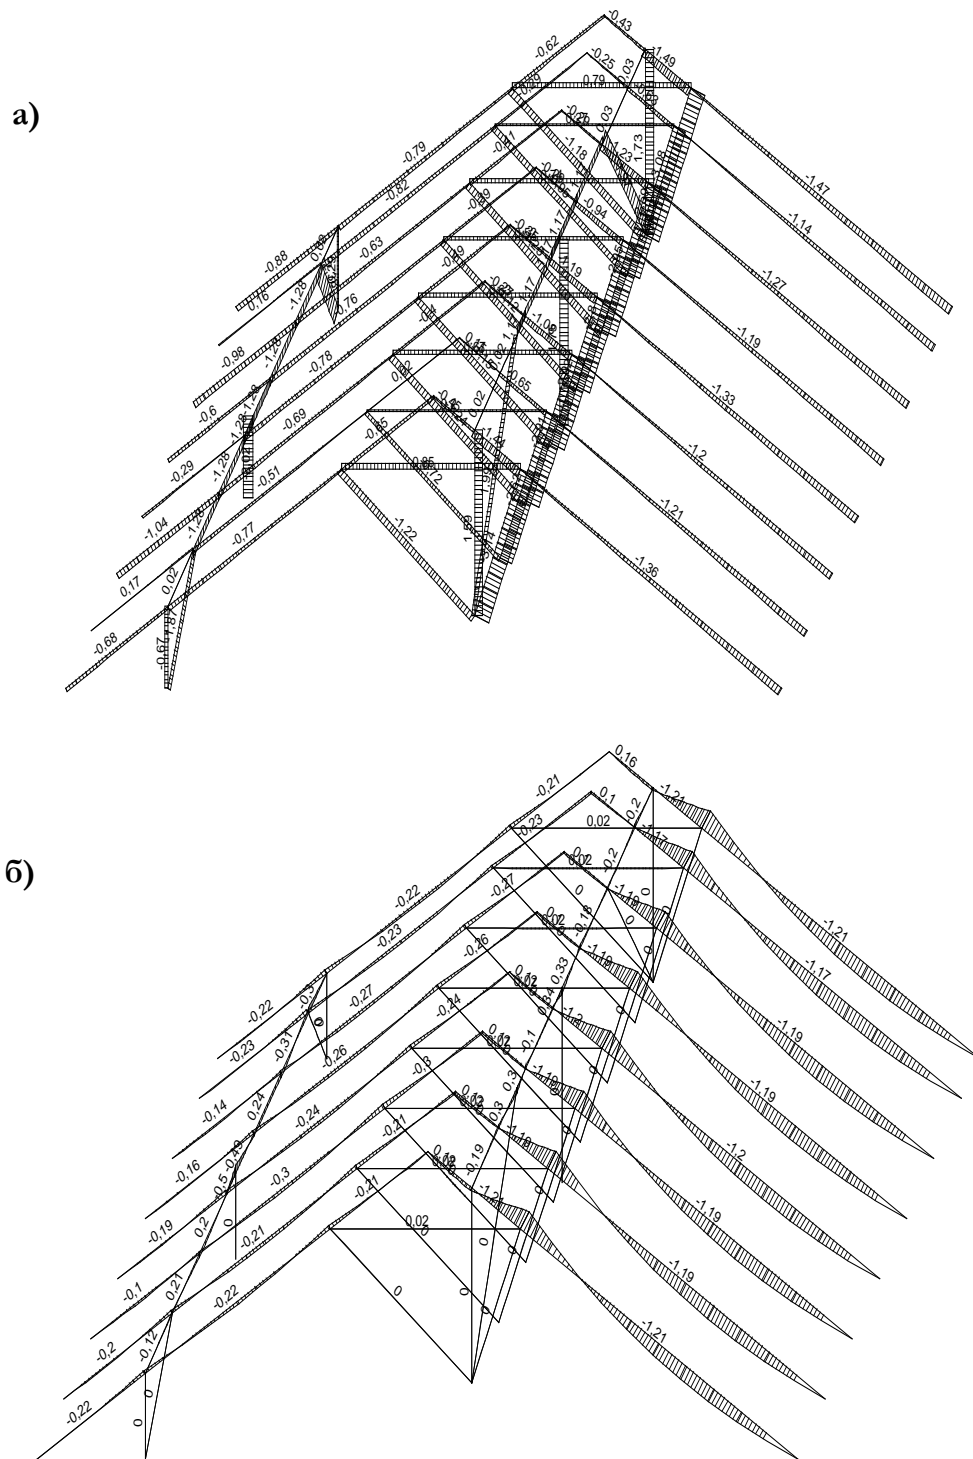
Эпюры внутренних усилий в поперечных сечениях элементов стропильной системы и перемещение ее узлов от расчетных значений нагрузки: а) эпюра продольных сил N , mc ; б) эпюра изгибающих моментов M , $m \times m$
